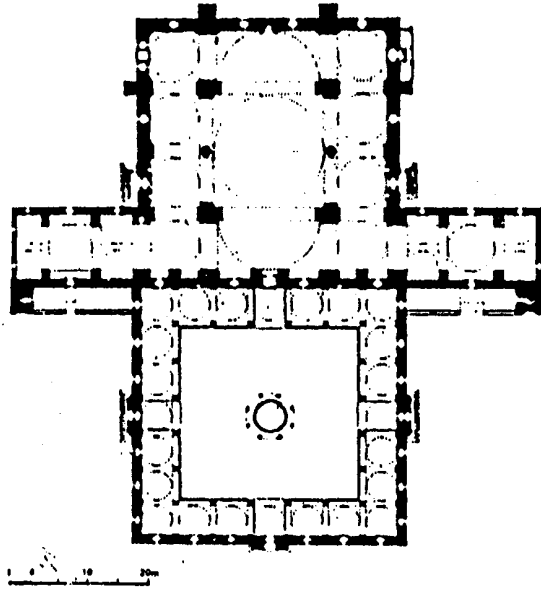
مسقط أفقي لجامع تترخان في كوزلوه بالقرم
